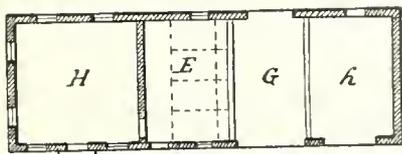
Plan d'une petite ferme du Jura bernois.
